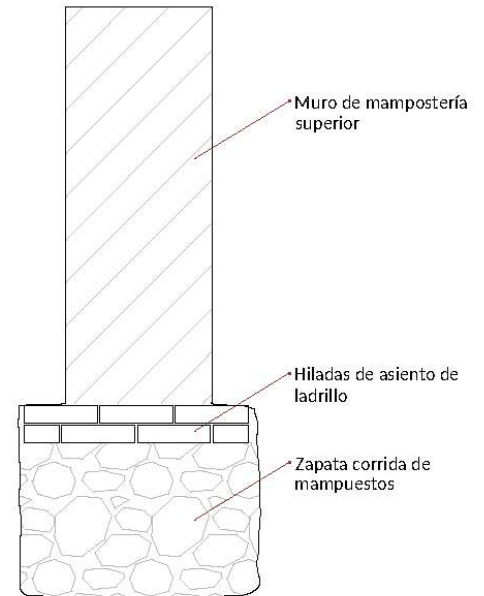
Imagen del arranque de un muro con cimentación de zapatas corridas con mampuestos. Fotografía no correspondiente a la Masía de la Almunia. Fuente: Pérez Vila.
